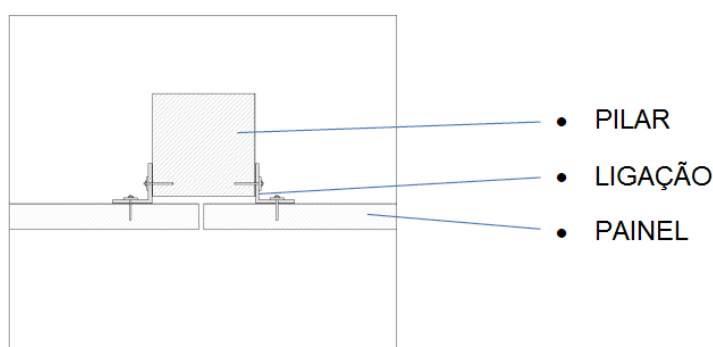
Exemplo de intervenção da ligação entre pilar e painel horizontal [1]
